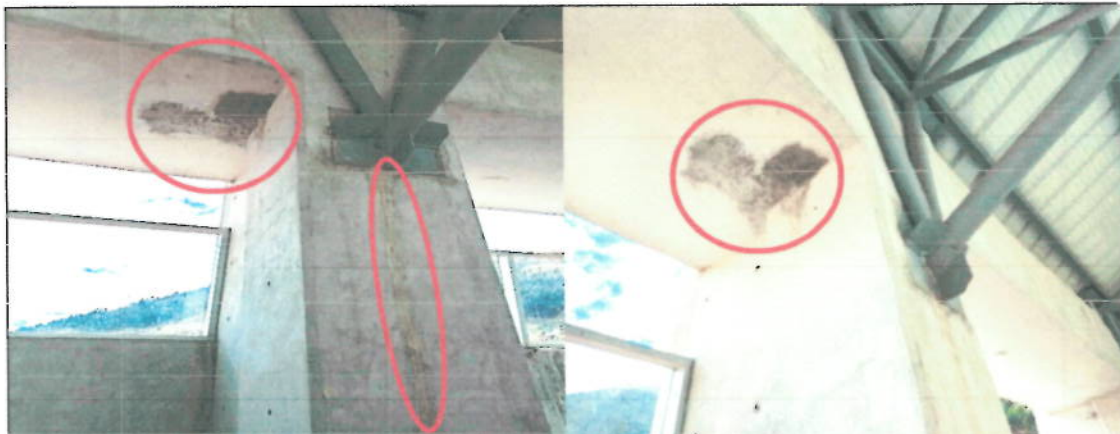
Se aprecia: filtración de aguas pluviales con presencia de óxido que desciende por las estructuras metálicas y columna.
